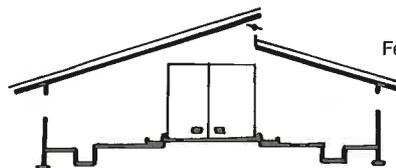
Différentes possibilités de ventiler une étable isolée (sans plafond, à stabulation entravée). Construction de la fente de faite sur le toit en bâtière selon Sauter.
